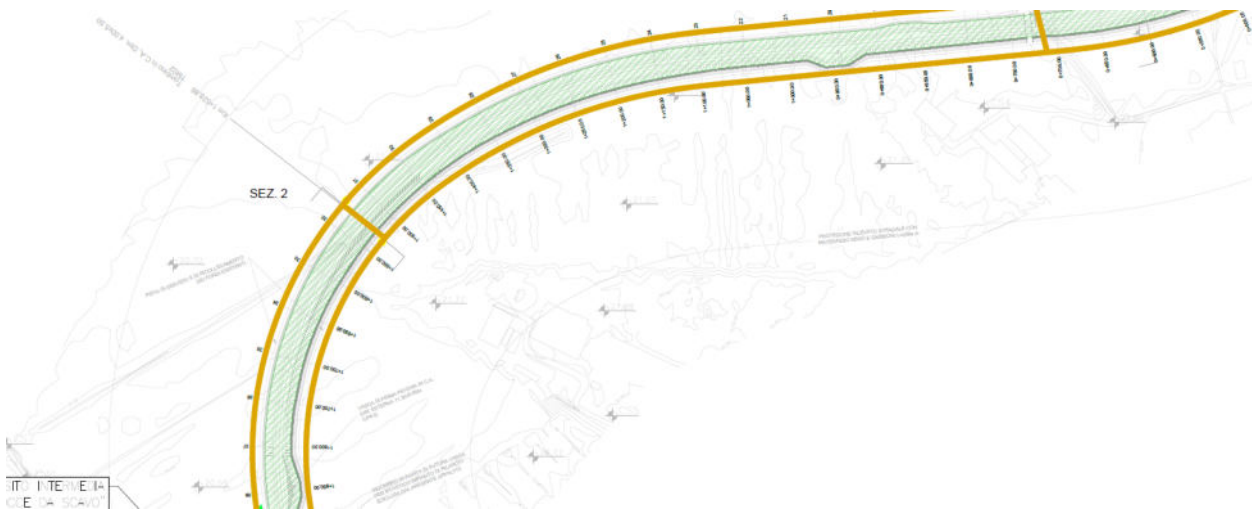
Stralcio planimetria T00-GE01-GEO-CD01
